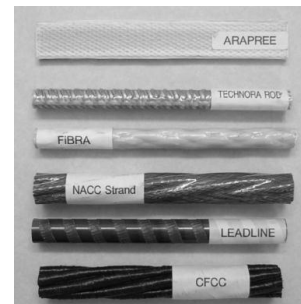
Cabos de FRP para estruturas de betão pré-esforçado [2.3]
